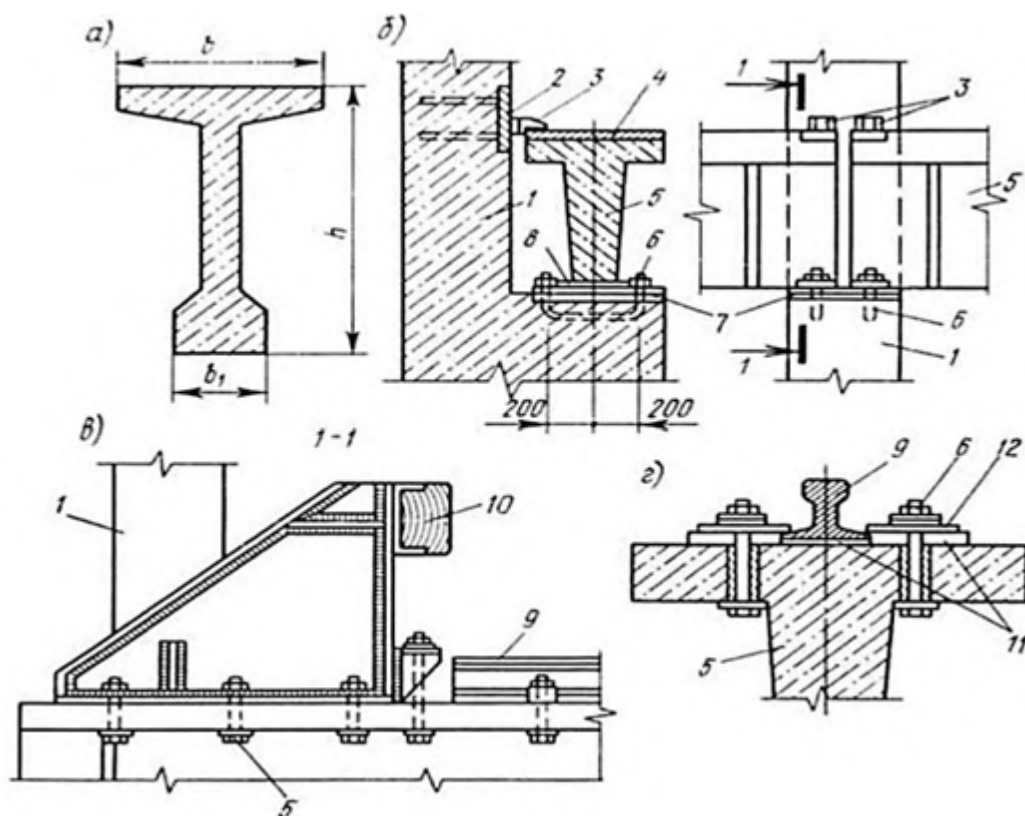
Вузли кріплення підканової балки: а - переин підранової блки; б - крілення підканової блки до консолі коони; в - упор мосового рану; г - крілення рельсу мостового крану; 1 - колона; 2 - заклана деаль в кооні; 3 - сталева плстина; 4 - заклана детль підкрнової балки; 5 - підкранова балка; 6 - болти; 7 - стлеві лити; 8 - заклдна детль блки; 9 - пікрановий рельс; 10 - дерев'яний рус; 11 - уруга прокадка; 12 - лапки
